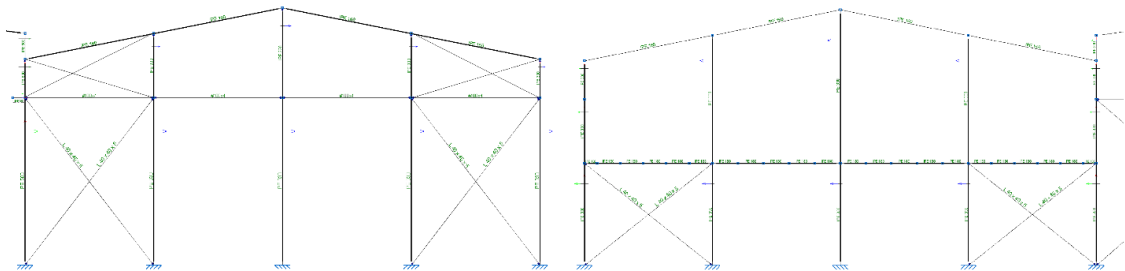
Pórticos de fachada de la nave secundaria; izquierda-principal y derecha-trasera
